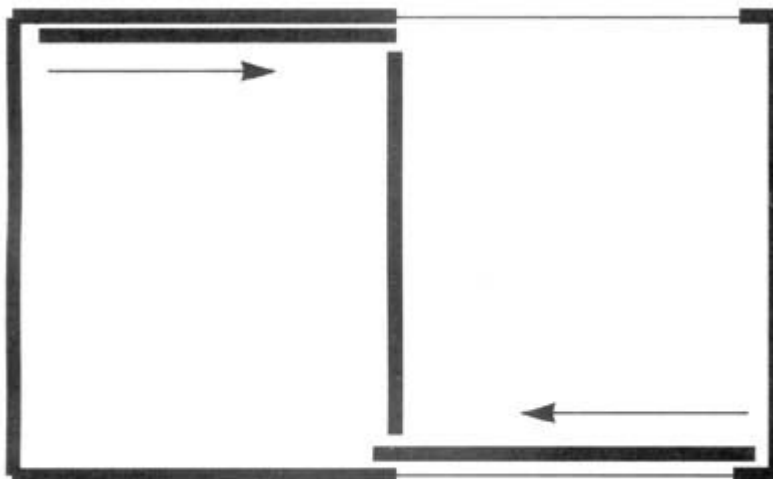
Шлюз с одностворчатыми раздвижными дверьми
